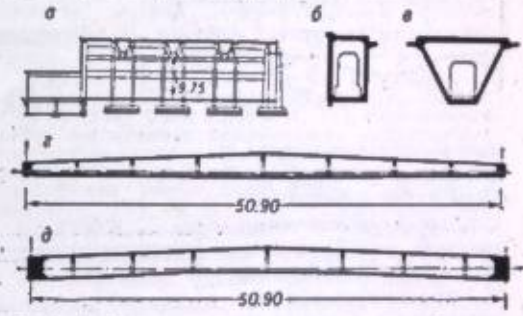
Предварительно напряженные балки пролетом 50,9 м (ангар в Бельгии): а — поперечный разрез ангара; б — сечение промежуточной балки; в — сечение наворотной балки; д — промежуточная балка.
